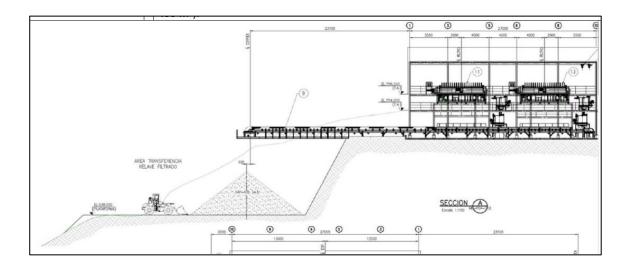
Disposición de obras. Fuente: Atacama Kozan.
